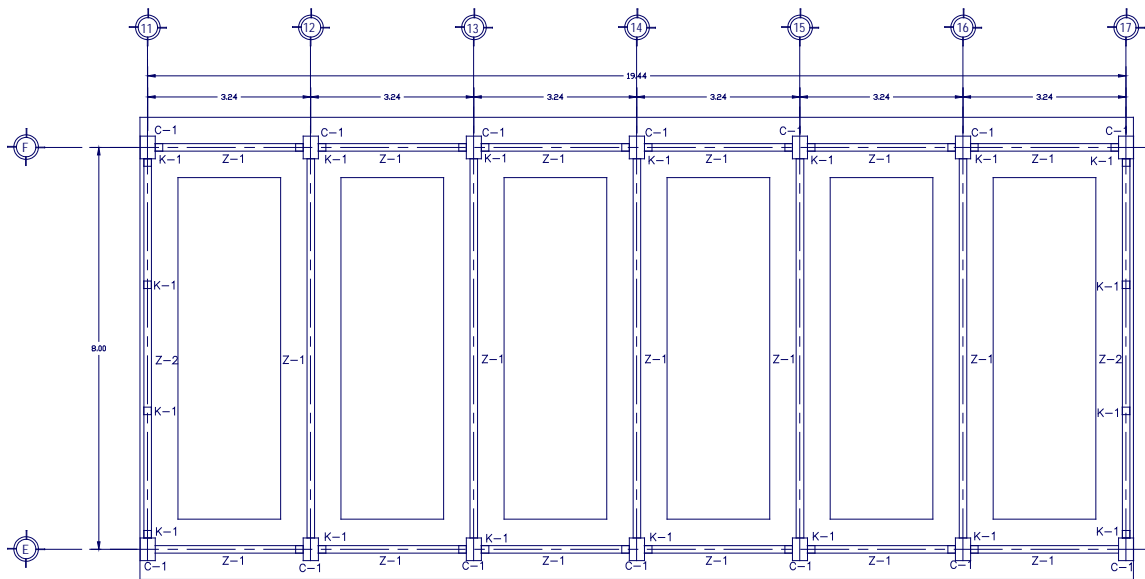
Plano de cimentación, guía para realizar el trazo y la excavación.
